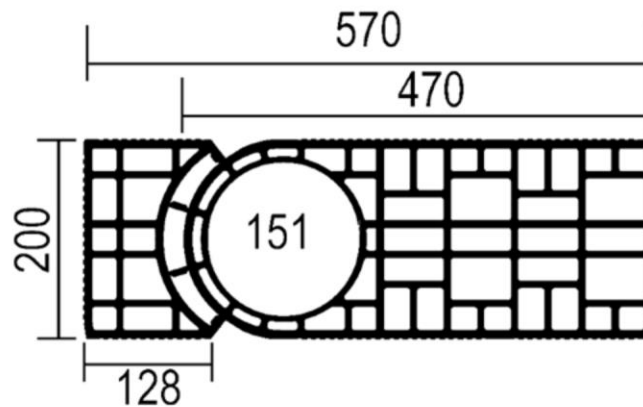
Poteau multi-angle (Diamètre réservation 150 mm)
